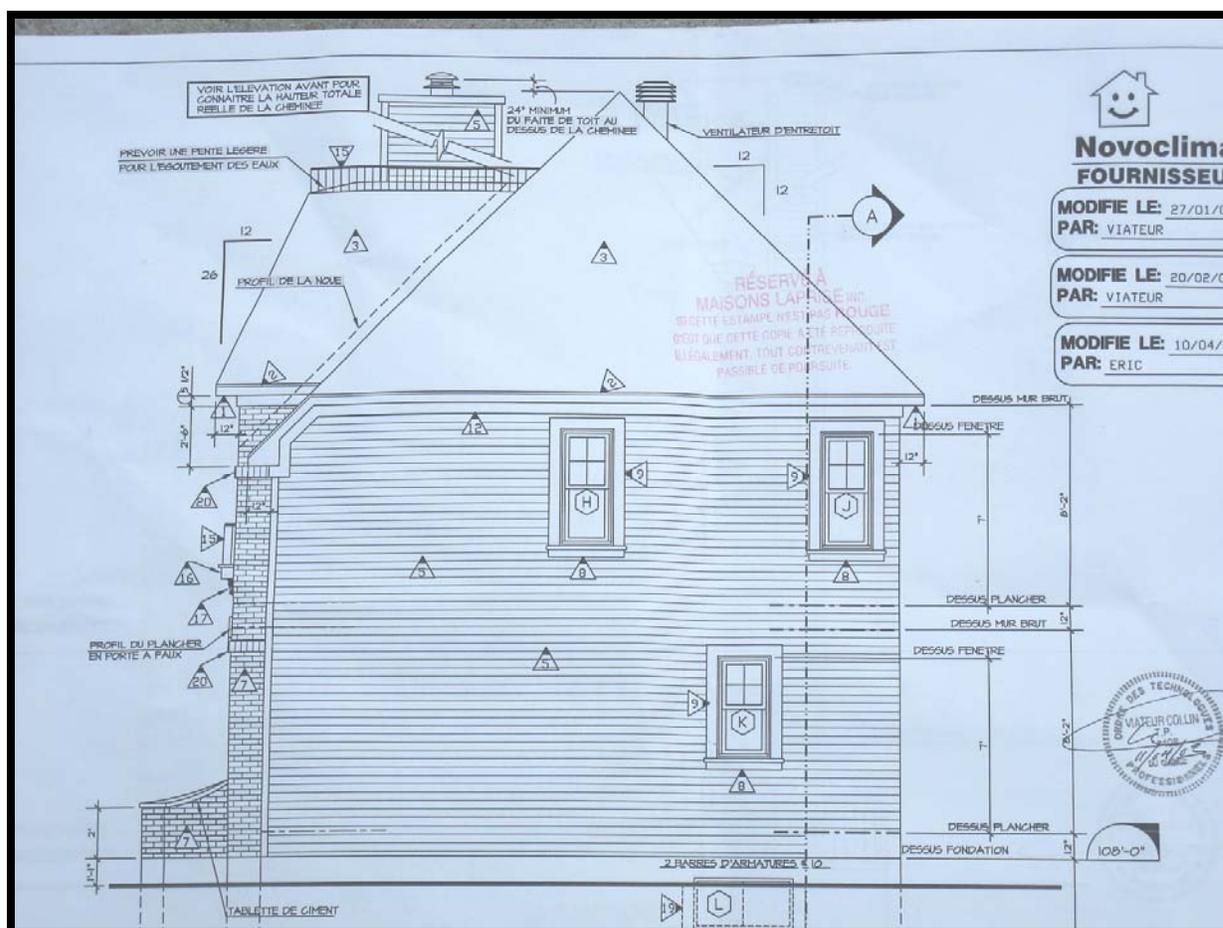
Élévation gauche du bâtiment (source : Plan du bâtiment fourni par le propriétaire)
